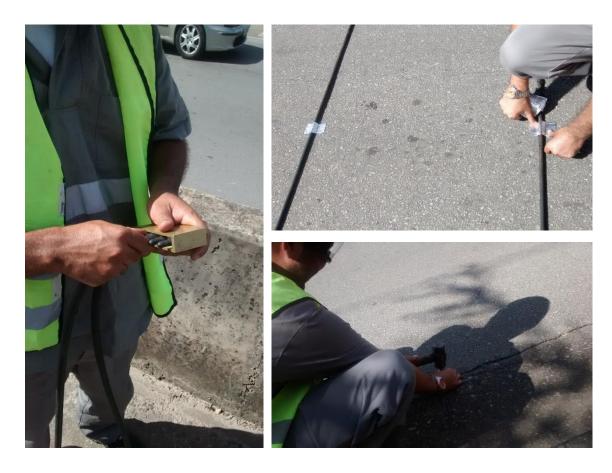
Instalação do Picocoounter 2500 juntamente com as mangueiras de ar.
